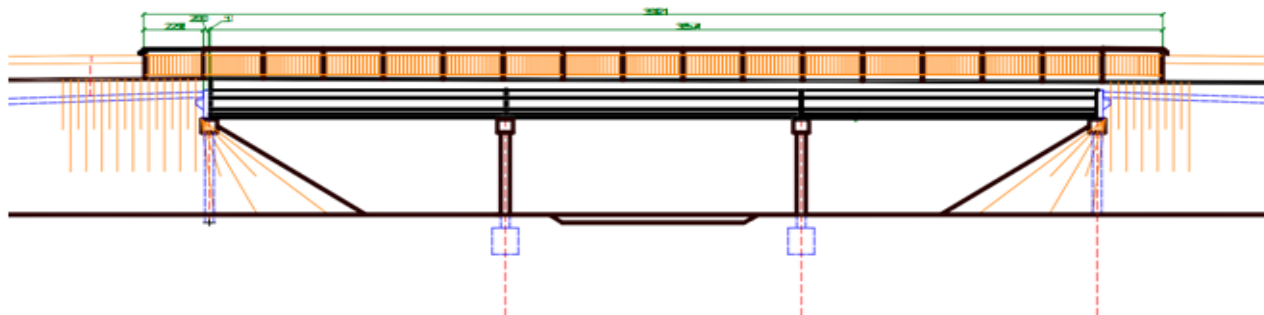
Варіант заміни старої прогонової будови на попередньо напружені залізобетонні балки
